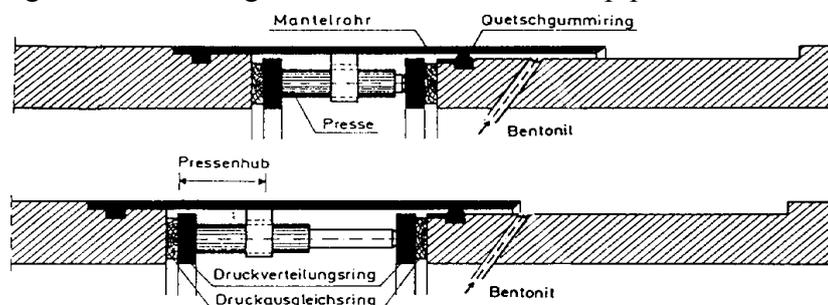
Zwischenpressstation während dem Vortrieb [18]
